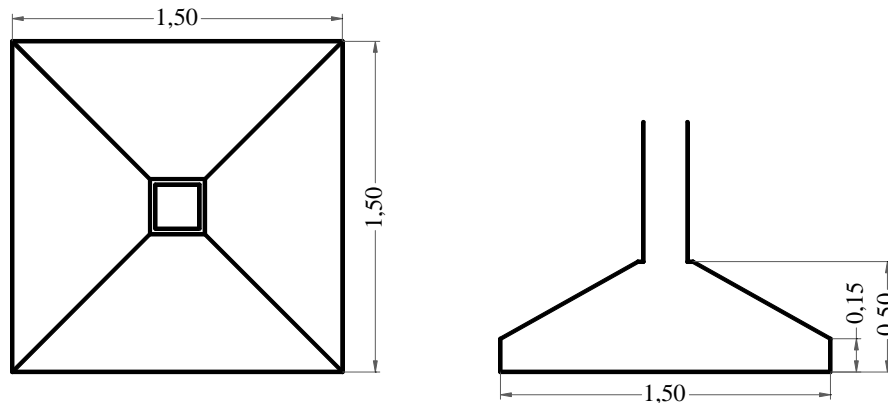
Base Tipo IV para Muros Portantes. Las Medidas están dadas en Metros
